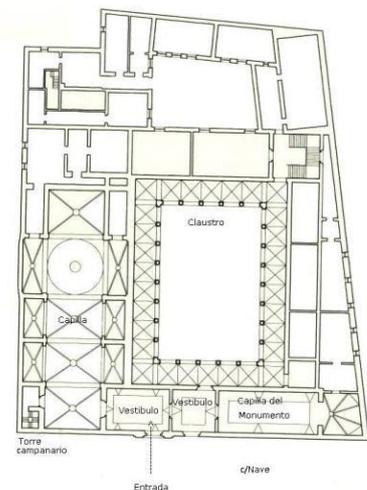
Plano de la planta del Colegio de seminaristas de Corpus Christi
